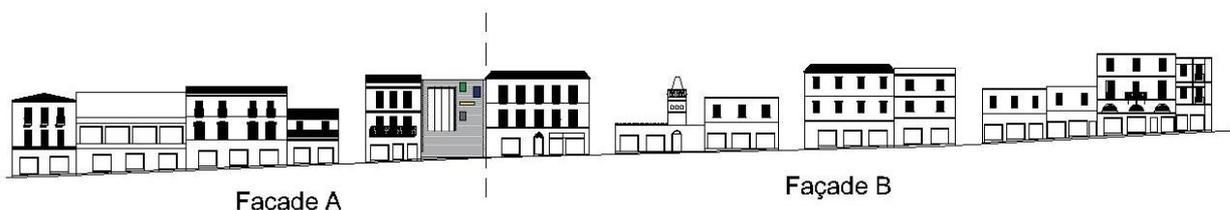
Façade sur la rue Bouras fait par les auteurs
